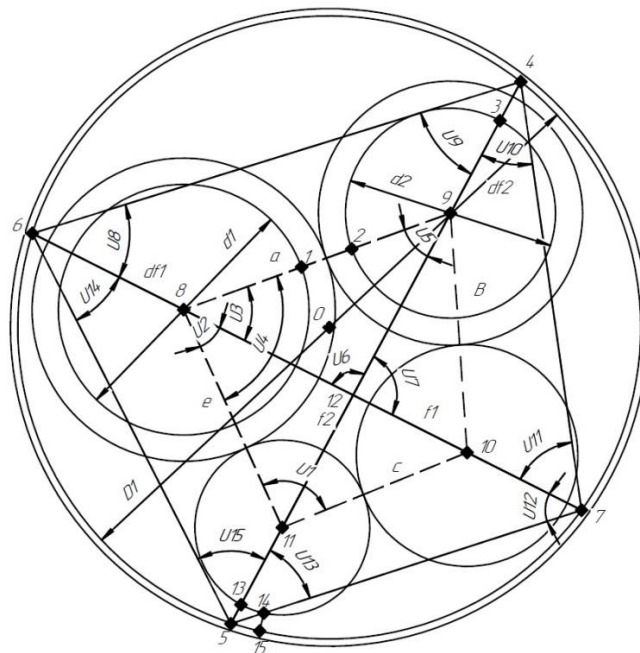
Поперечное сечение четырехствольной дымовой трубы Fig. 1. Cross section of four-barrel stack
